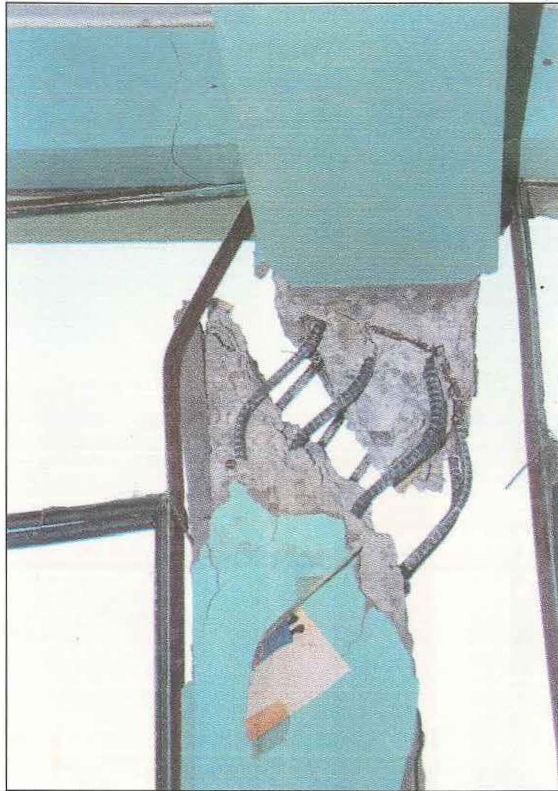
Falla de cortante en columna exterior del Centro Educativo Angela Barrios, Moquegua.
